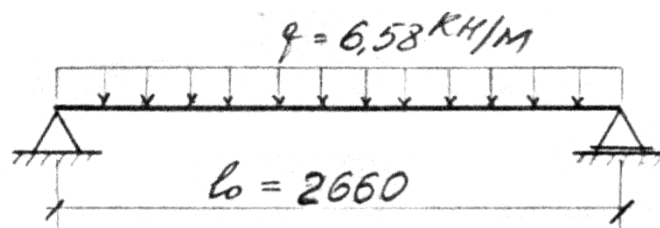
Розрахункова схема ступені сходового маршу
